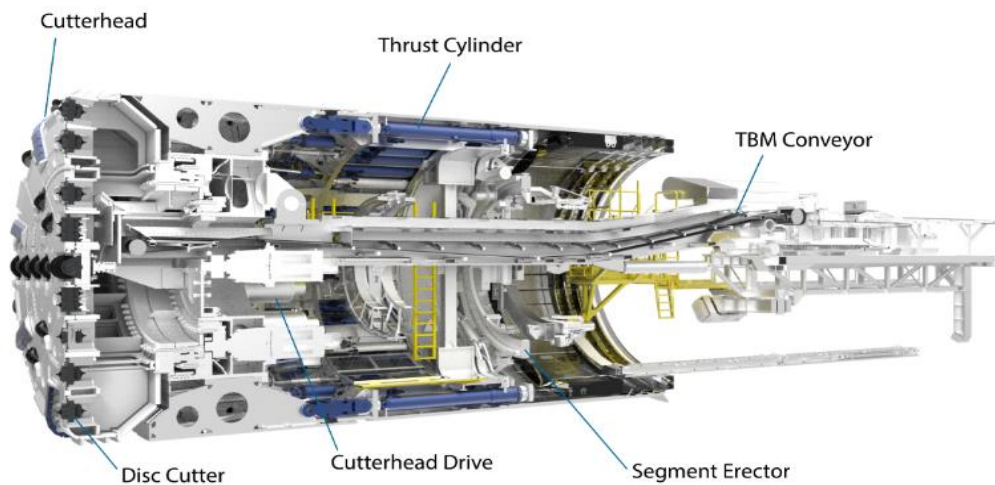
Tuneladora escudo sencillo. Imagen: The Robbins Company, <https://www.therobbinscompany.com/products/tunnel-boring-machines/single-shield/single-shield-detail/>
